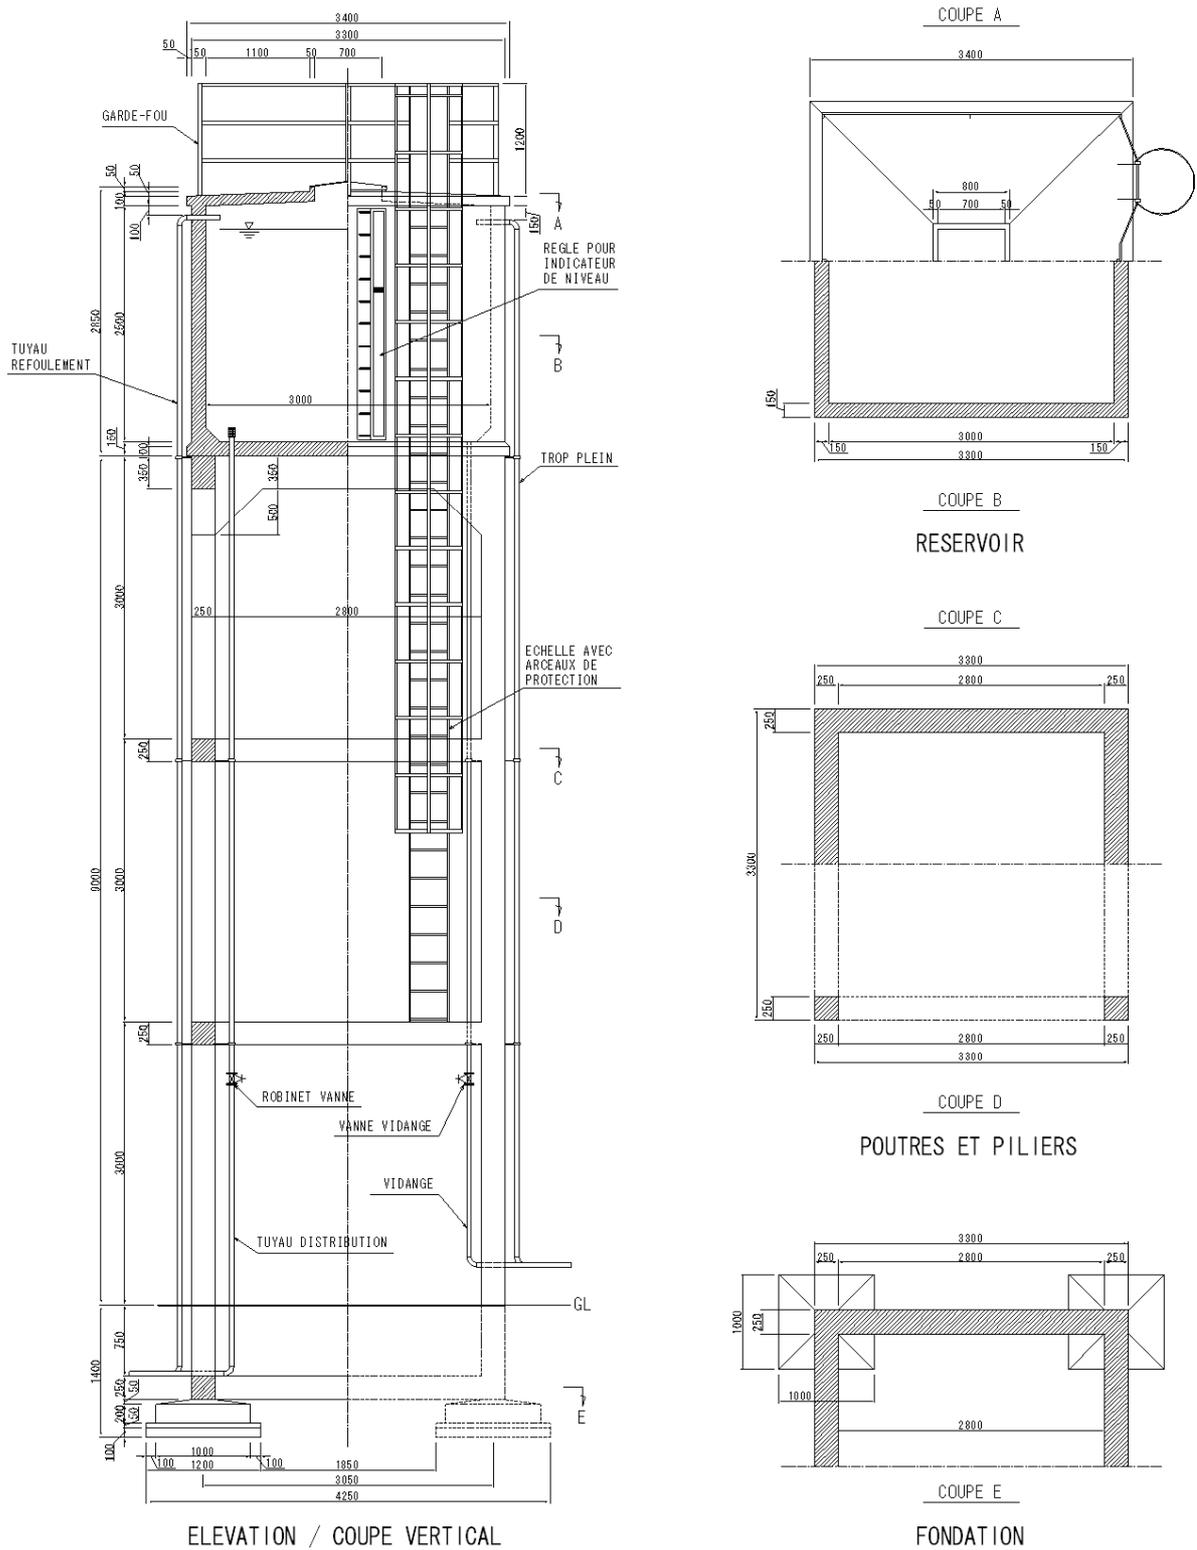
Plan structural standard de château d'eau (20 m<sup>3</sup>, H = 9 m)
